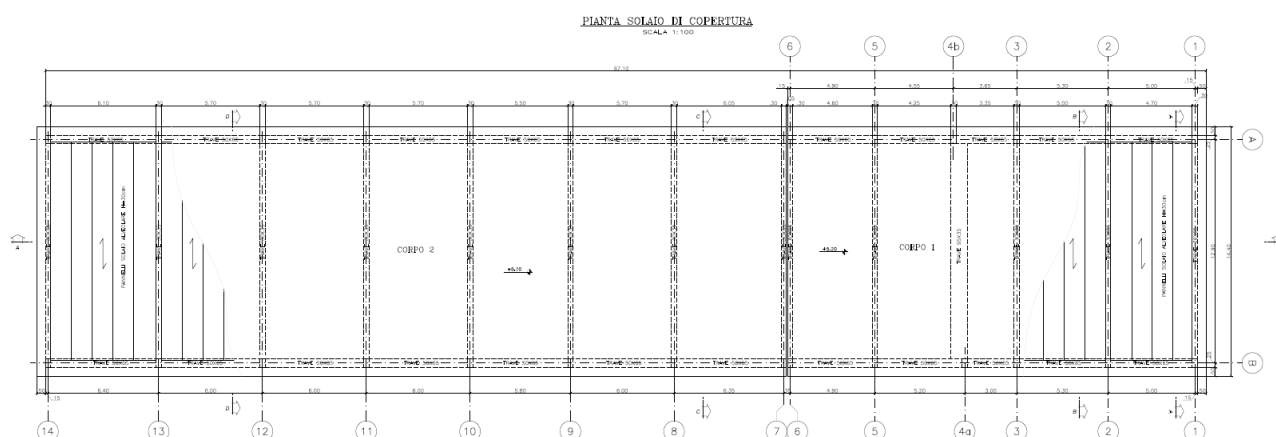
Pianta carpenteria solaio di copertura della sottostazione elettrica.
